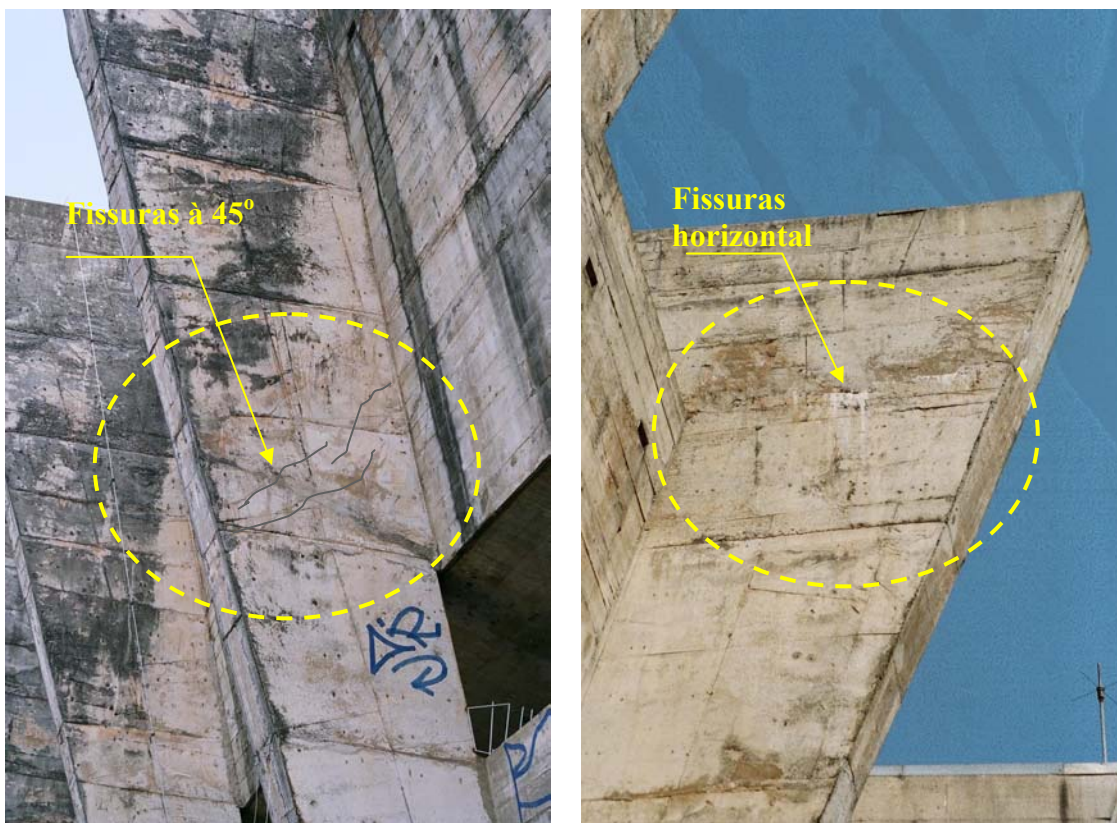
Na foto da esquerda é mostrado um exemplo de fissura a 45° no canto superior do pilar. À direita, uma fissura horizontal também na parte superior dos pilares externos (fissura realçada). Ambas as fissuras têm origem na concentração de tensões nesta região
